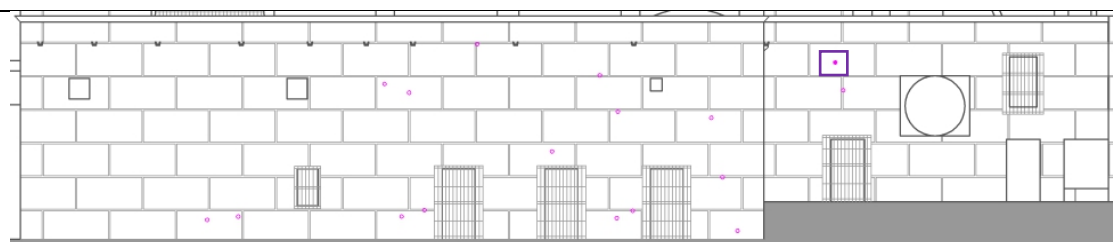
Hendiduras en paramento por impacto de proyectiles. Detalle fachada Este
